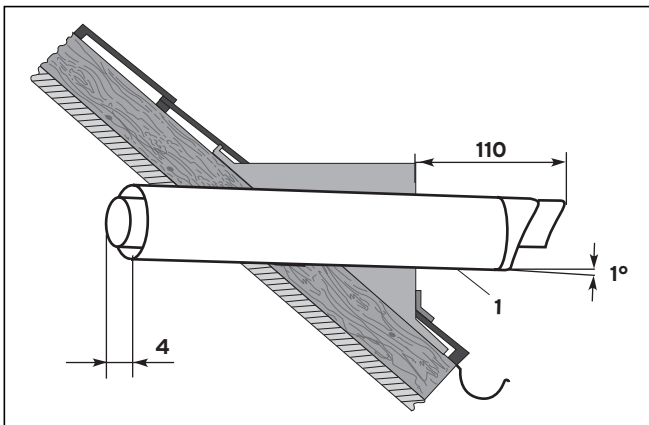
Příklad montáže vodorovného prostupu stěnou/střechou (střešní vikýř)
